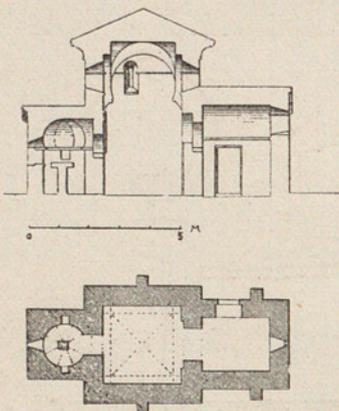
CORTE Y PLANTA DE SAN MIGUEL DE CELANOVA.
